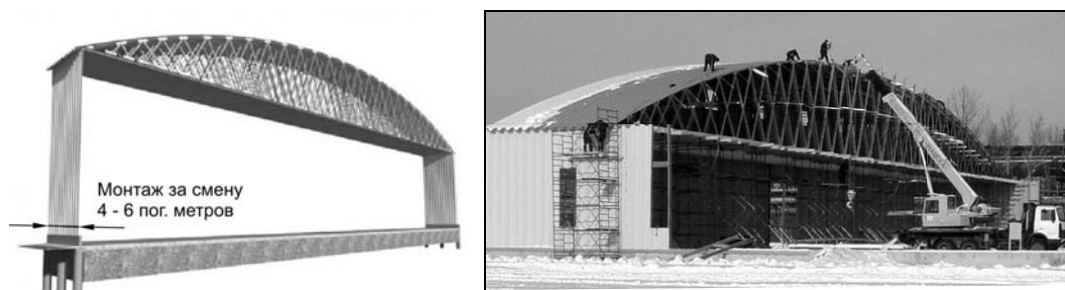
Монтаж несущих конструкций бескаркасного здания
